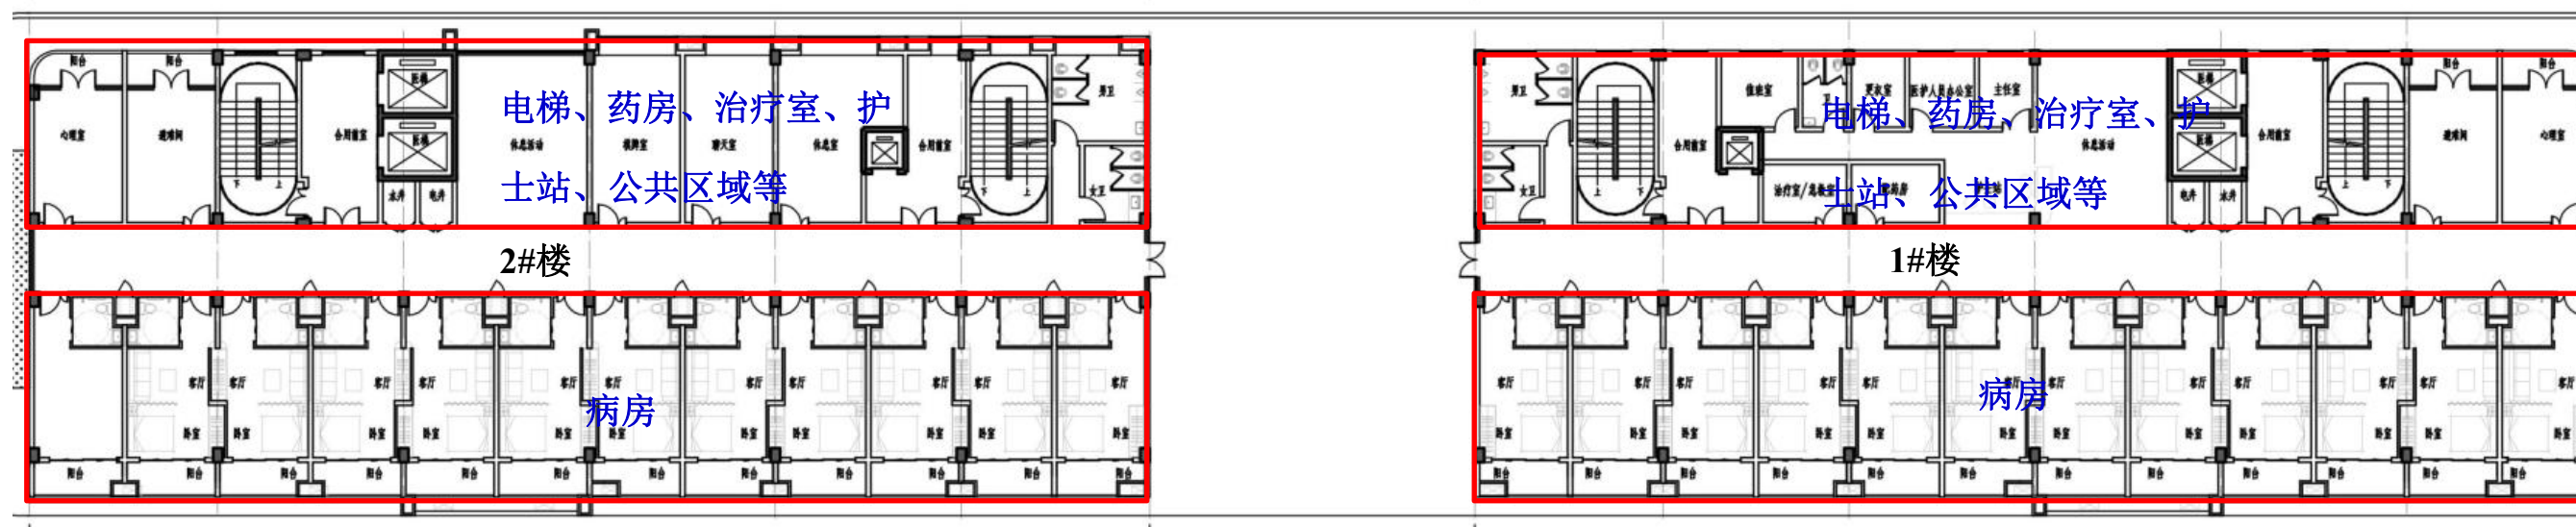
1#、2#护理楼三~十层平面图 (其中 2#护理楼十一、十二楼与三~十层平面图相同)
